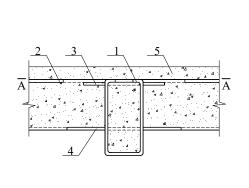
内衬板焊接连接构造示意图 1-开孔矩形钢管; 2-混凝土翼板; 3-内衬板
